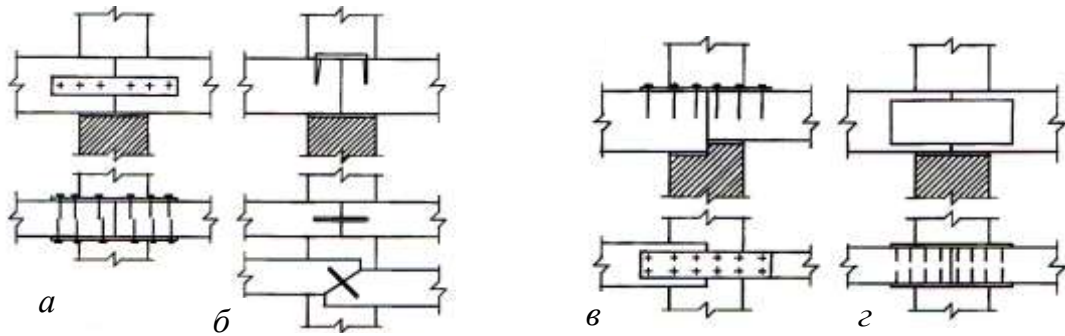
З'єднання дерев'яних балок перекриттів за спирання на внутрішні стіни:
